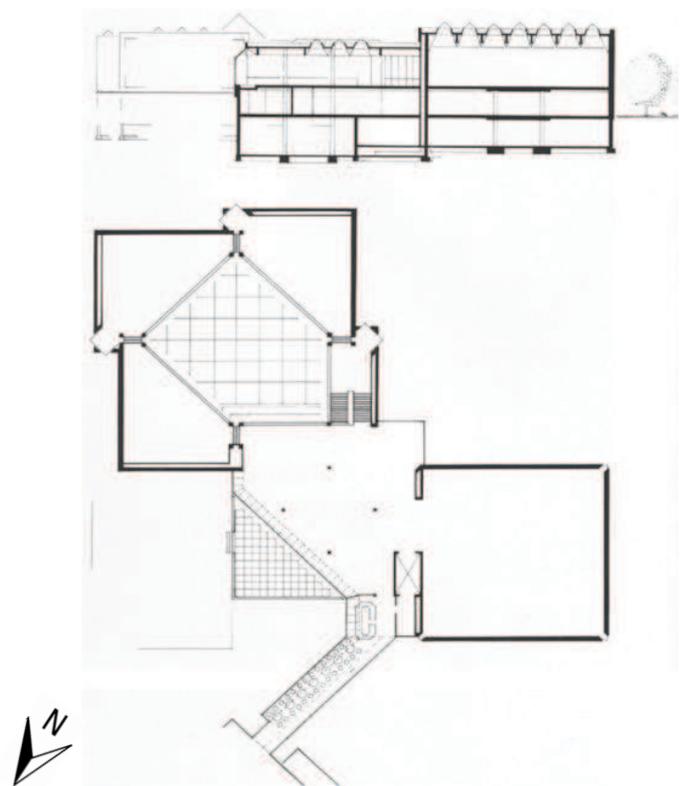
Grundriss und Schnitt des 3. BA (aus: Geisler-Hansson 1988/ 1, S. 112)
